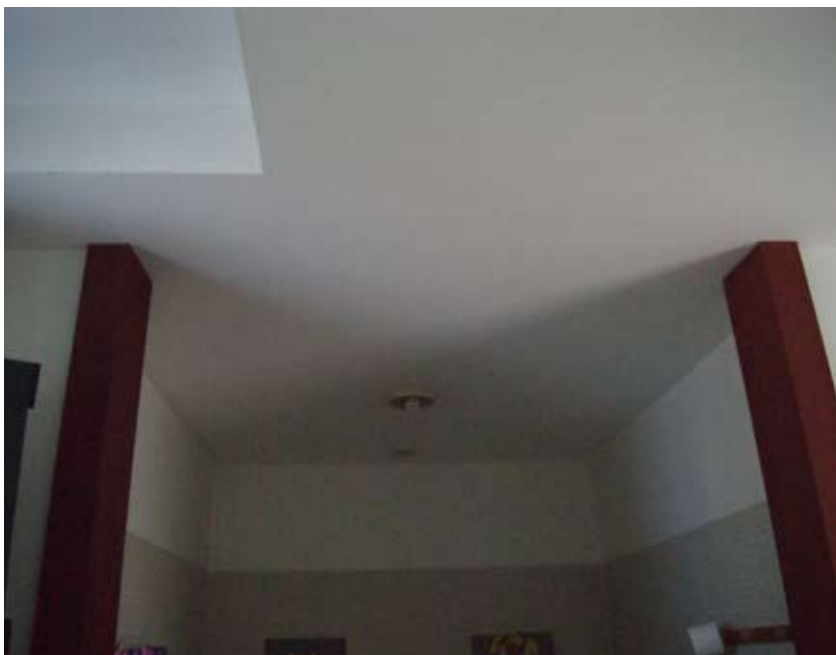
Controsoffitto dall'aspetto moderno nella Associação de Apoio à Criança.
